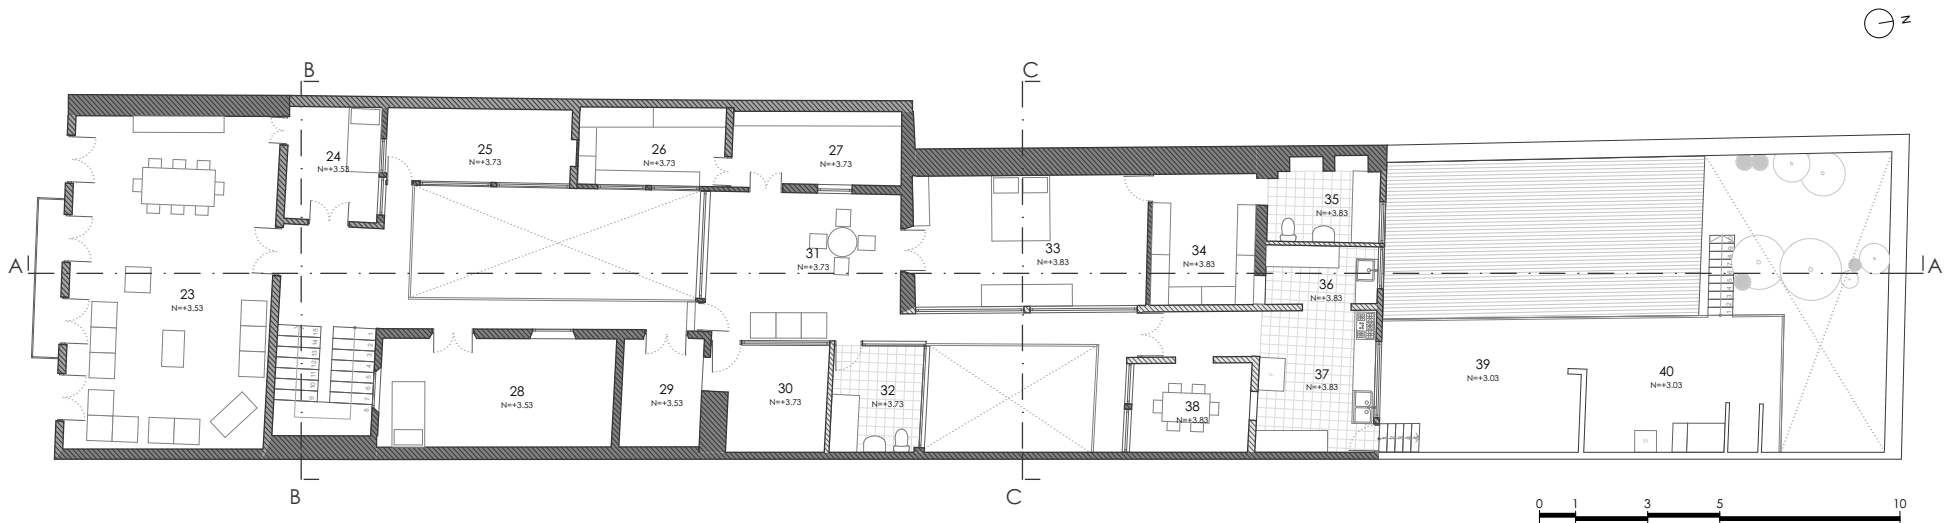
Planta Alta | Caso de estudio 2, Vivienda Berrezueta.
